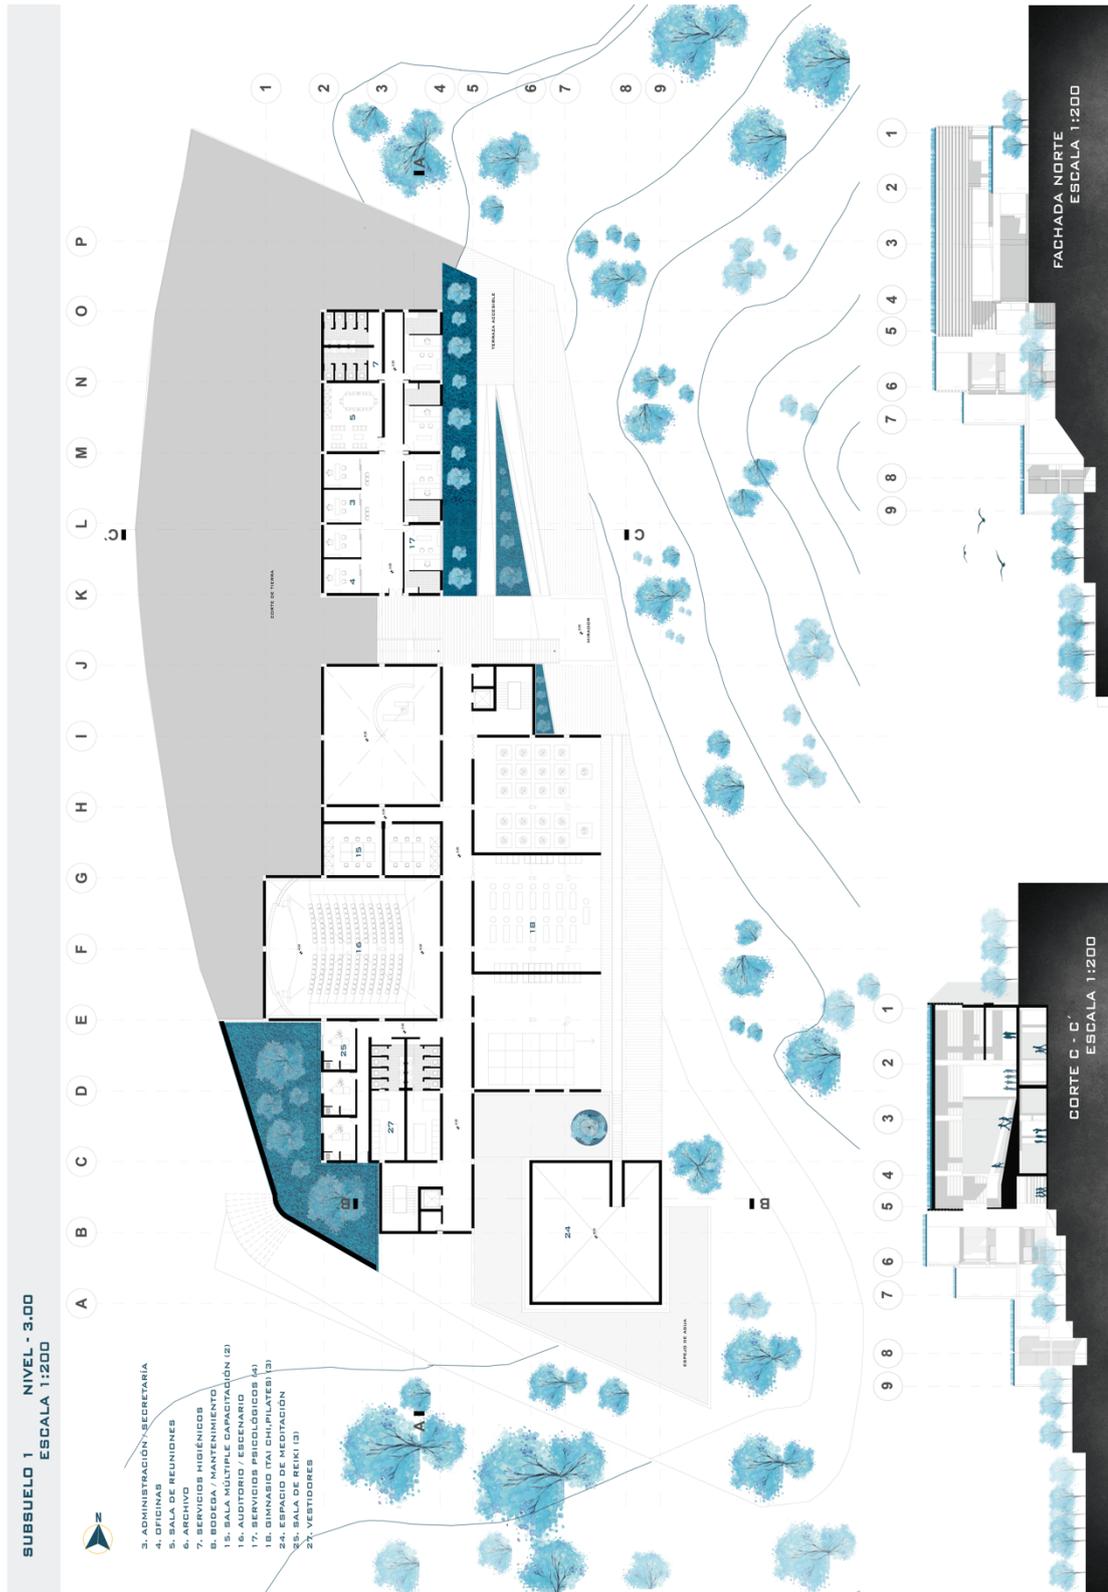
Subsuelo 1 / Corte Transversal C-C' / Fachada Norte. (Elemento Propio)
